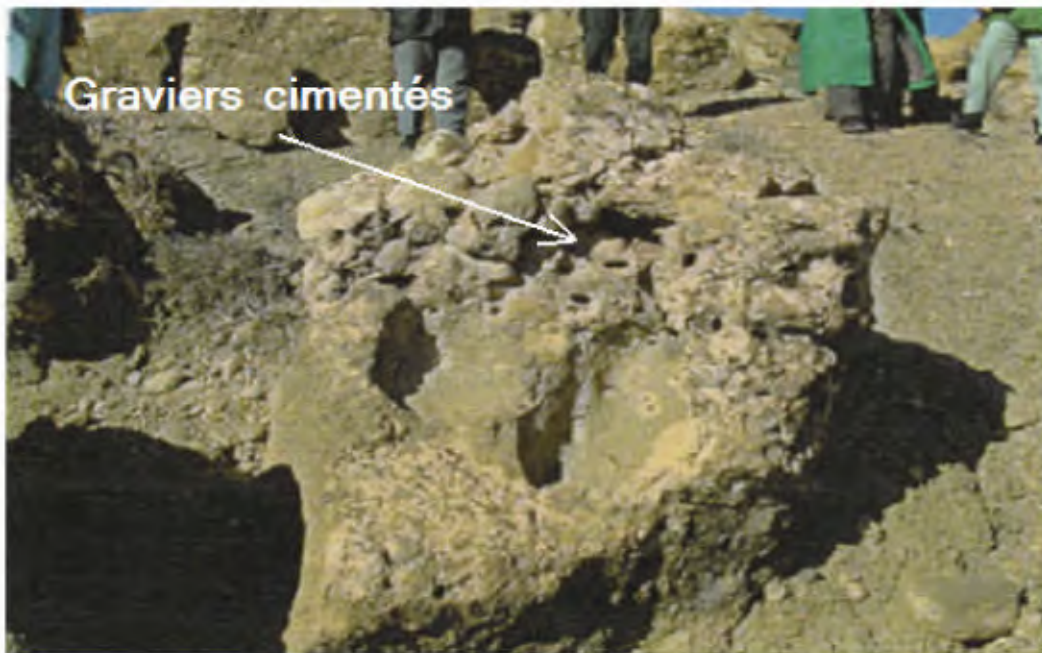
Graviers cimentés observés en partie supérieure de la rive droite 300 mètres enivrent à l'amont de site de barrage
